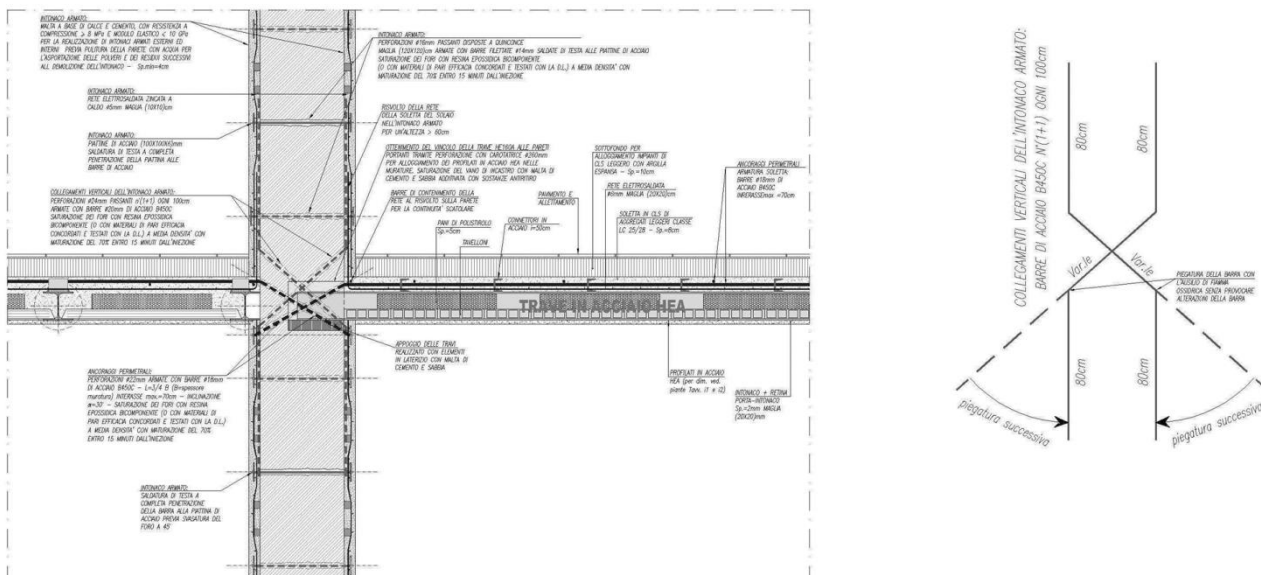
Collegamenti verticali dell'intonaco armato alla struttura muraria in corrispondenza dei collegamenti con i solai. Caso del solaio da conservare, con orditura in acciaio, vincolato alla muratura interna all'edificio (disegni originali di Massimo Mariani)
